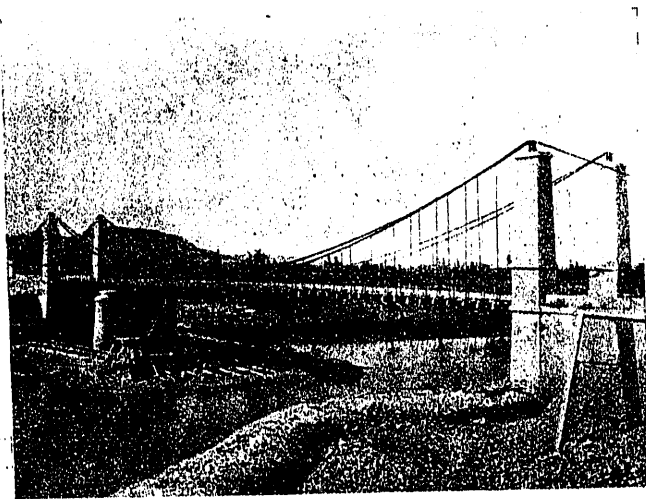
ª Puente colgante y ataguía para la cimentación de la primera pila del nuevo puente.
